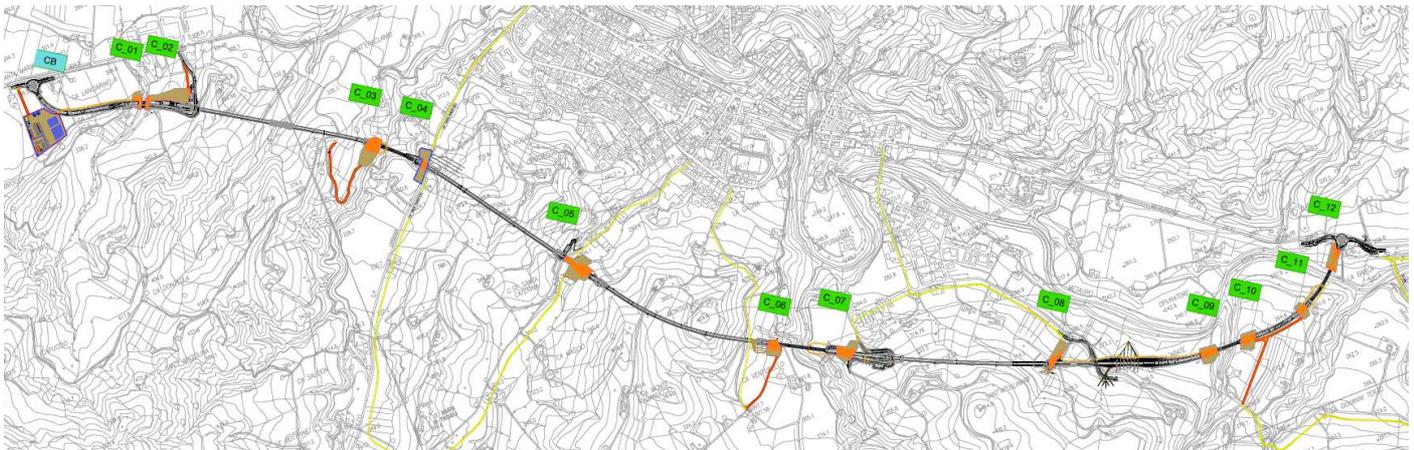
Estratto planimetria interventi di mitigazione - Aree di cantiere (T001A08AMBPR01)
